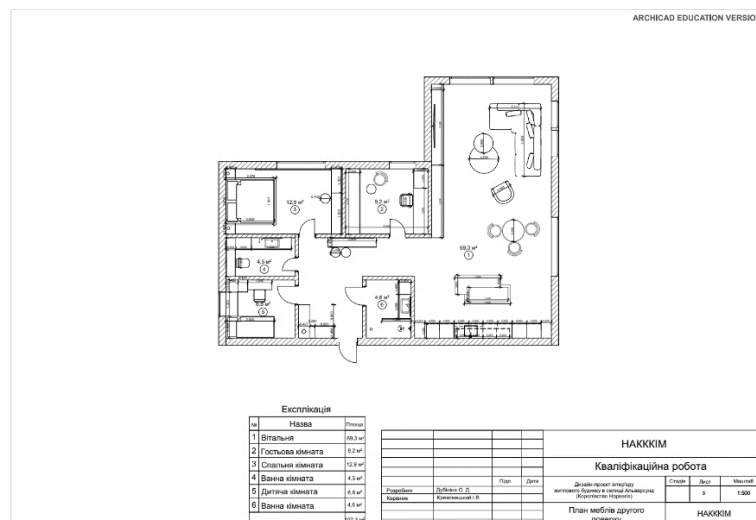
Планувальна схема другого поверху: а) схема розташування меблів з розмірами
